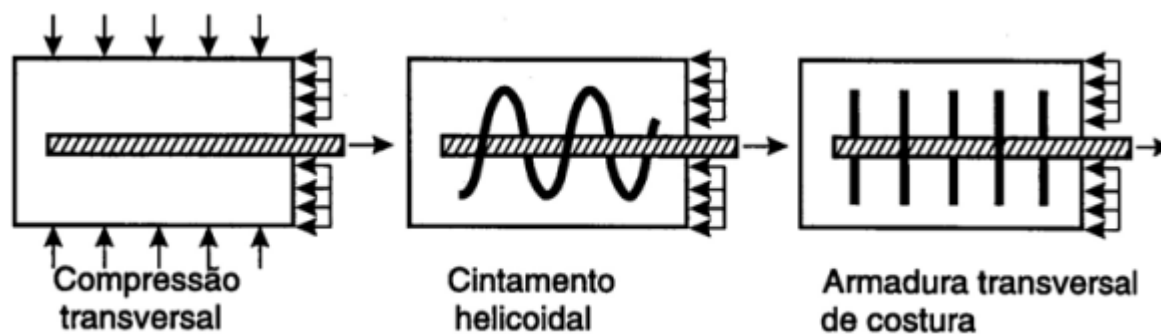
Armadura para evitar fissura de fendilhamento na ancoragem reta (FUSCO, 1995)
